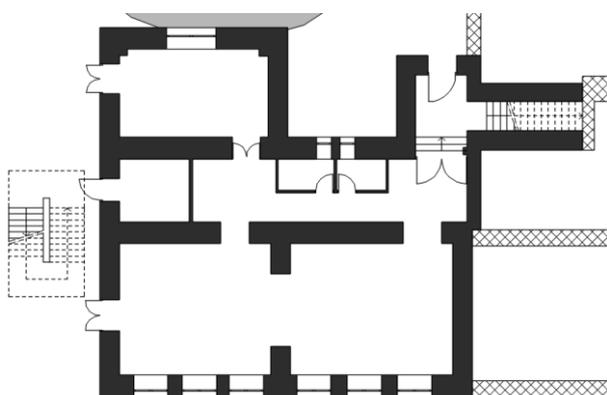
PLANTA PLANO SEMINTERRATO
